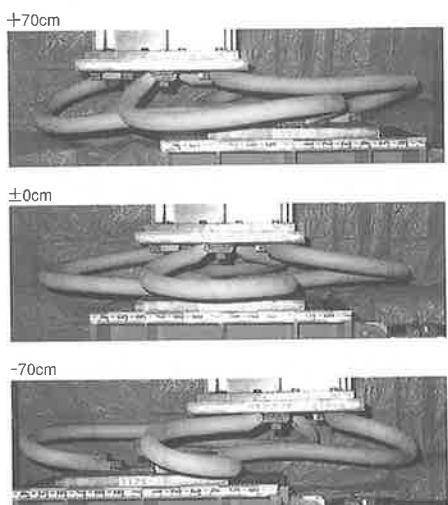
TSD ϕ 90R365変形状況写真（A方向）
